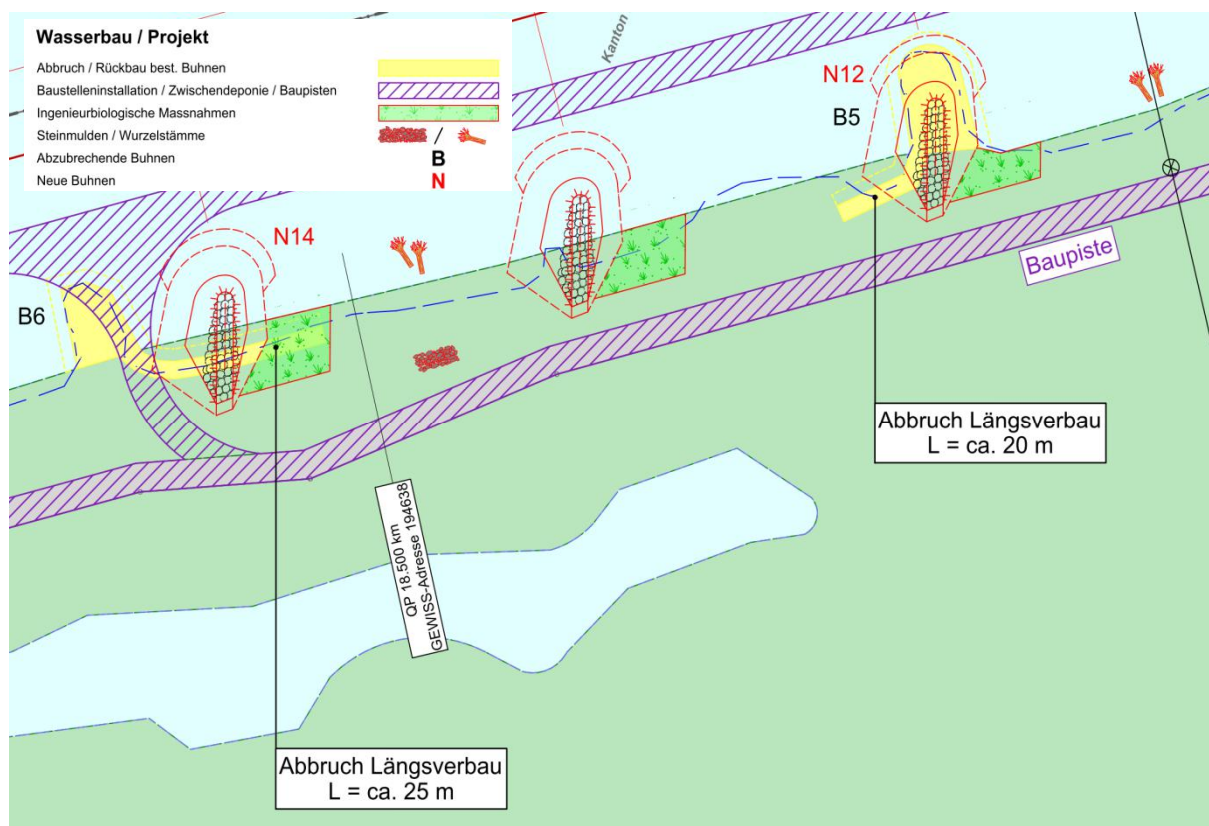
Angepasster Situationsplan: Steinhäufen wurden durch Steinmulden ersetzt, Totholzhaufen im Wald wurden gestrichen, der Abbruch der Betonlängswerke ist beschriftet.
